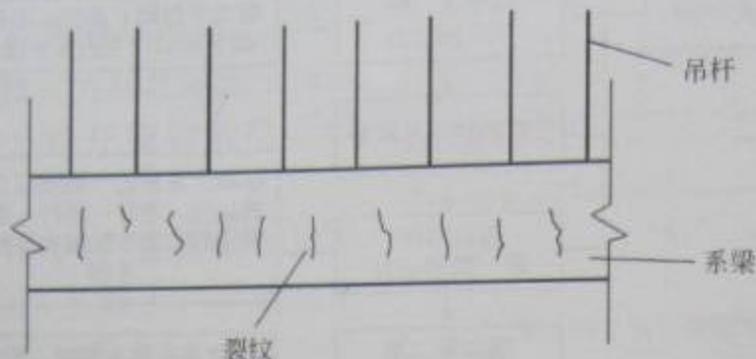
带劲性骨架的混凝土系杆的病害(局部图)
